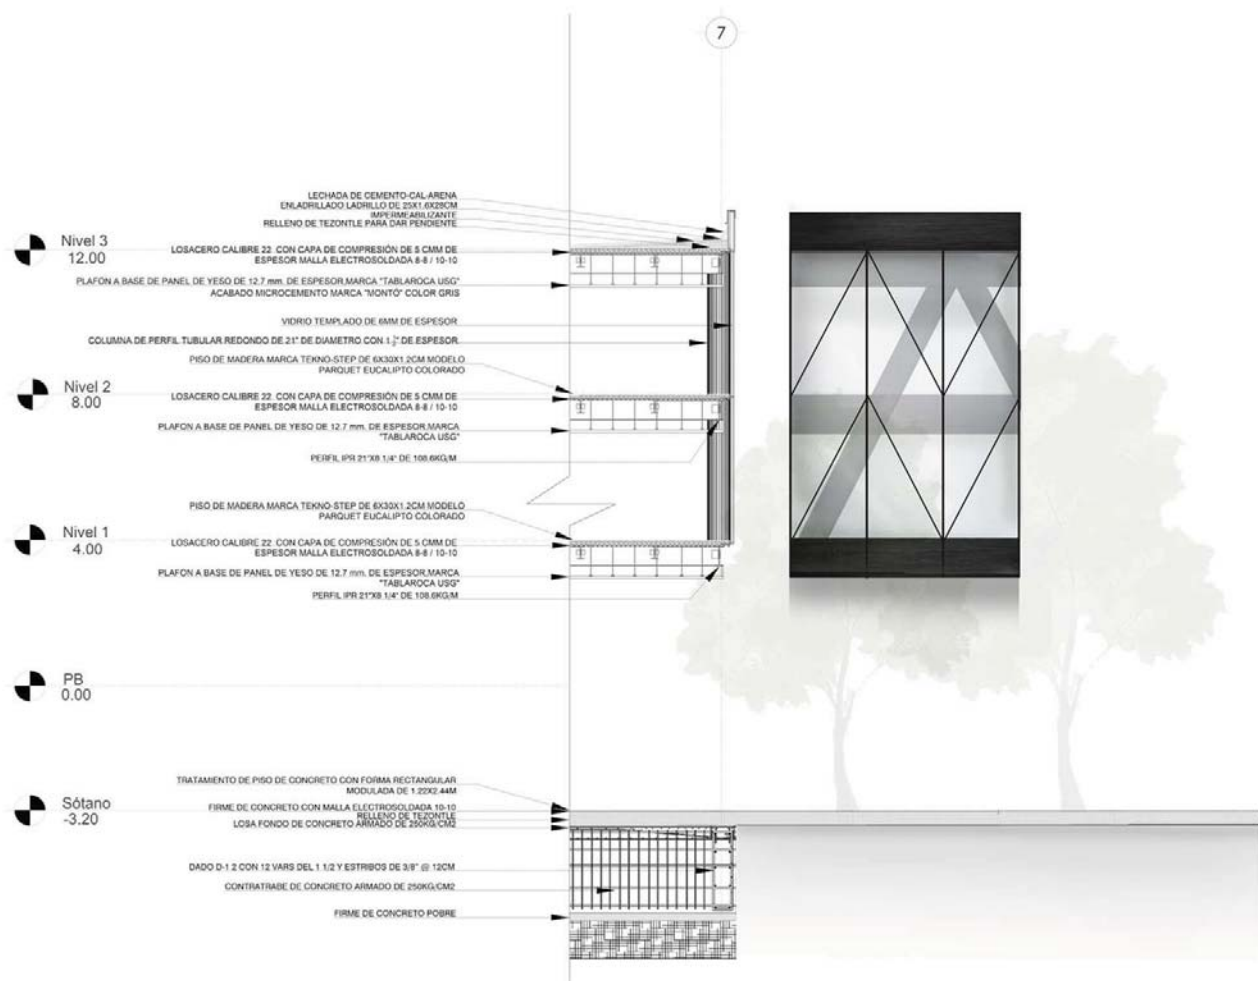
Corte por fachada CXF-02 [elaboración propia].
